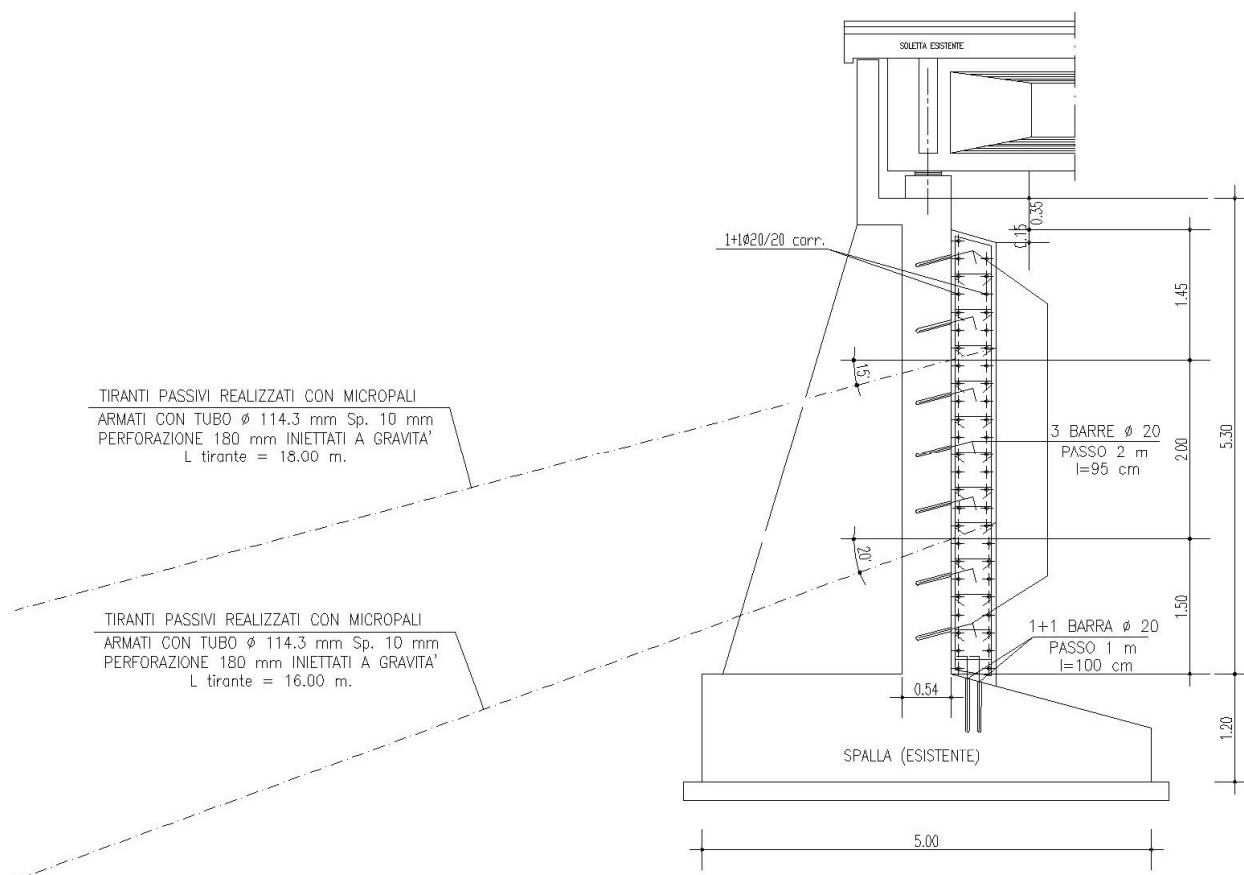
Spalle – Sezione tipo rinforzo strutturale
